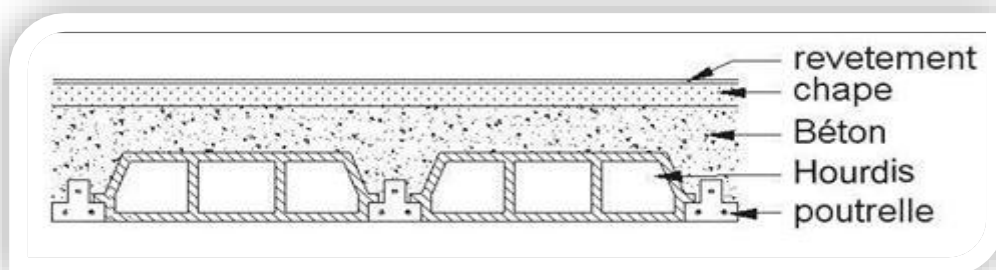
Coupe verticale du plancher d'étage courant
